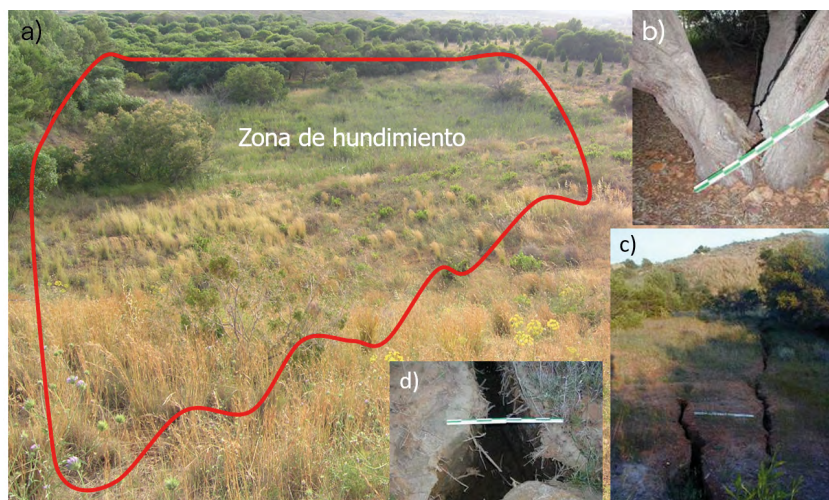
Riesgos geotécnico-estructurales en las presas de lodos mineros (presa de relaves) Marqués de Pejar, a) colapso, b) agrietamiento del tronco de los árboles indicativo de colapso o subsidencia, c) grietas de tracción de decenas de metros, d) detalle de las grietas de tracción donde se aprecia el ancho.
